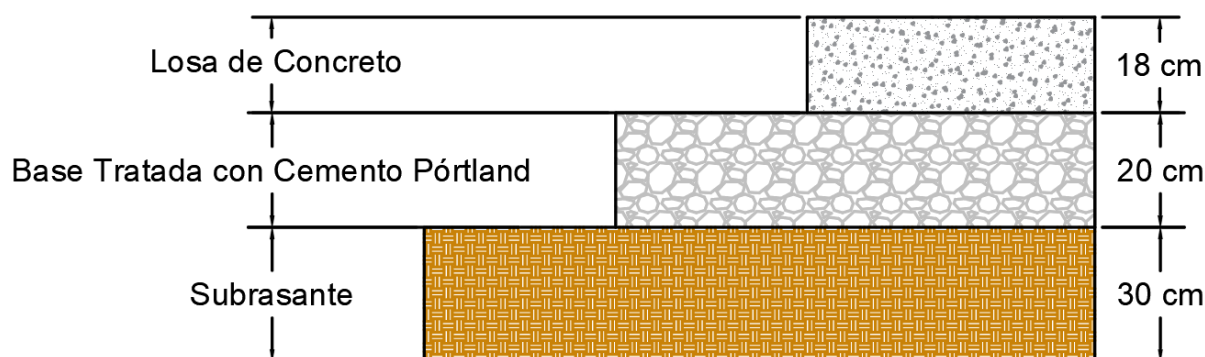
Sección Estructural para la Base Tratada con Cemento Pórtland- Alt.2
